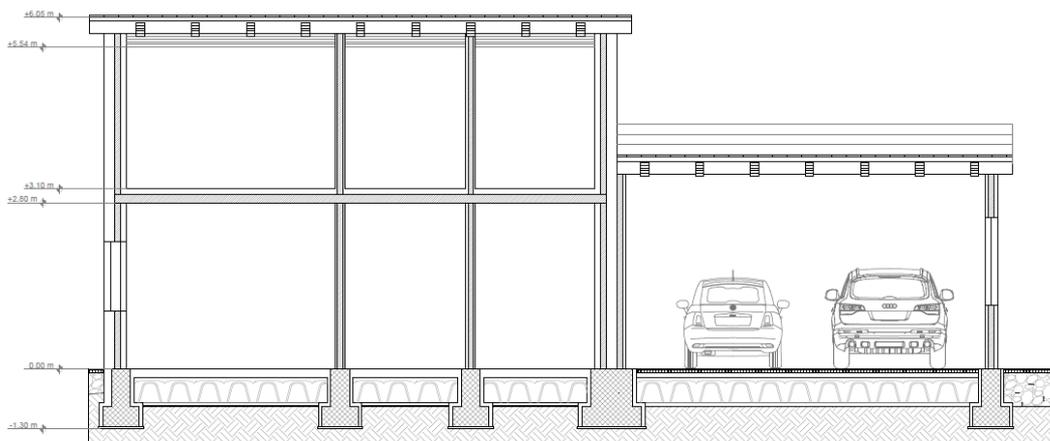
Sezione longitudinale e trasversale dell'edificio.
